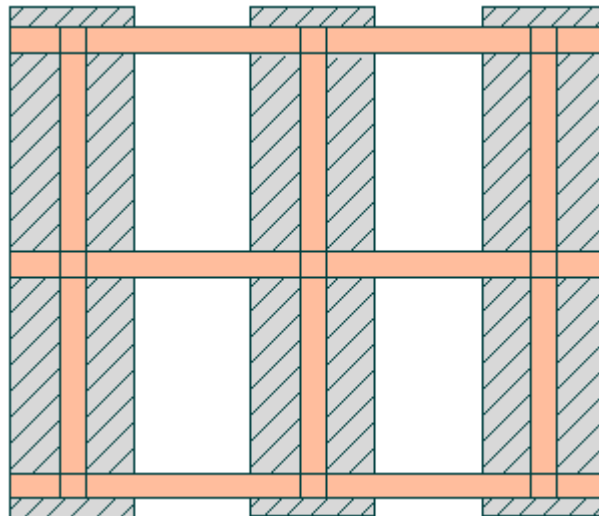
Alternativa de cimentación consistente en un entramado de zapatas continuas en una dirección, y vigas de cimentación rígidas en la otra dirección.
